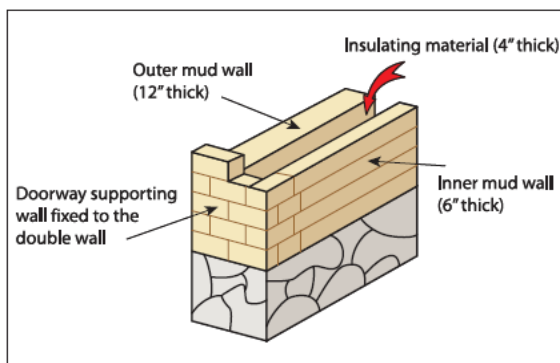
El procedimiento de albañilería para la construcción del muro para apoyar la puerta
